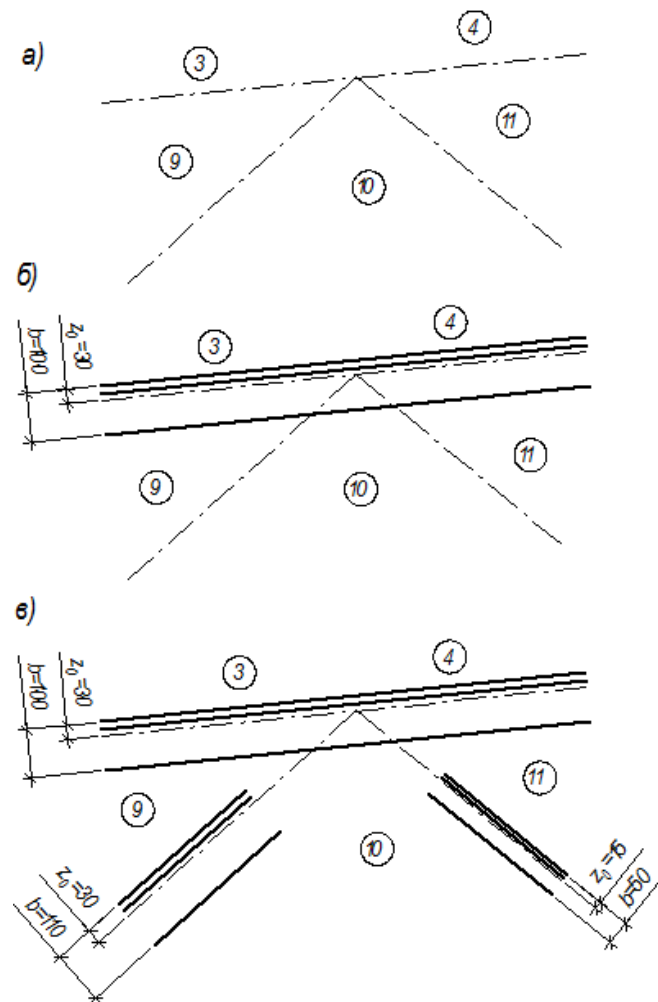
Початковий етап конструювання проміжного вузла
